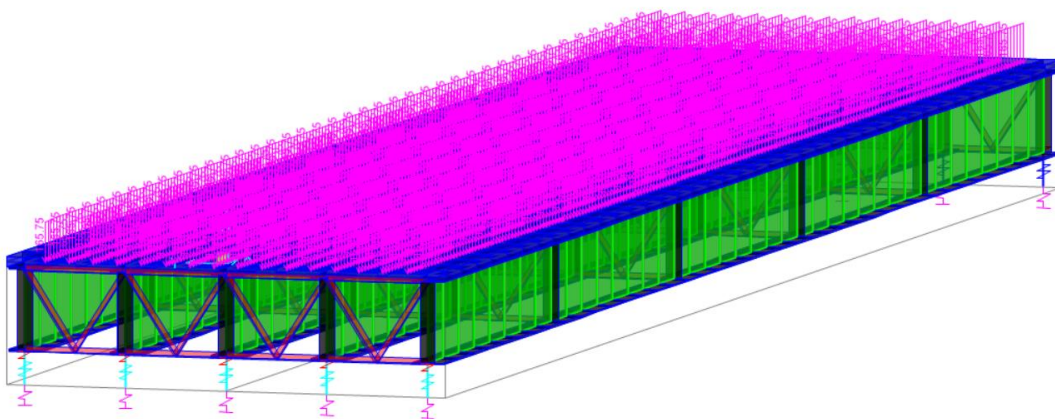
Carga muerta aplicada en CSi Bridge. Elaboración propia
